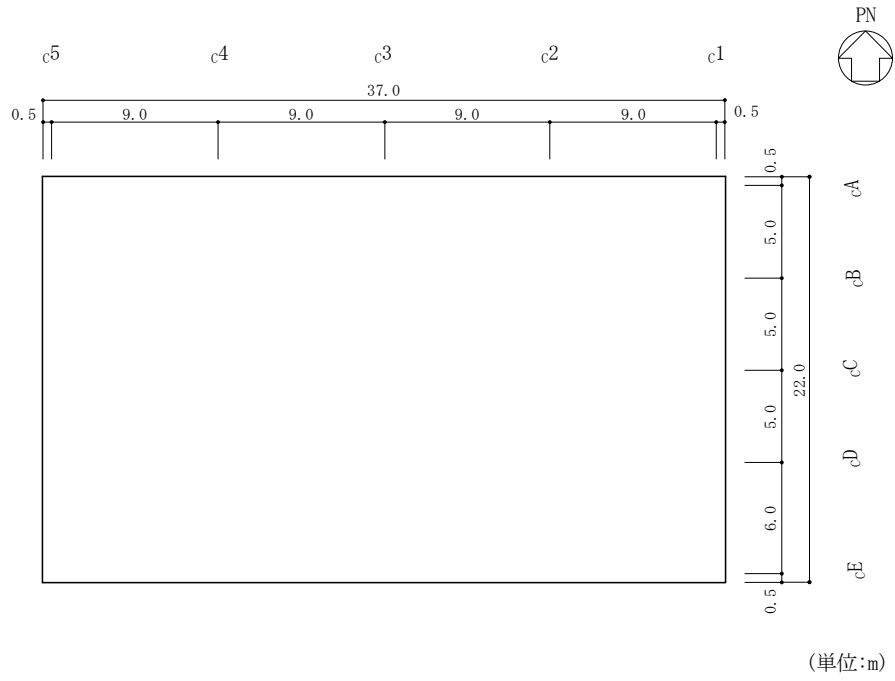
(5) 制御室建物の概略平面図 (EL 22.05m)
